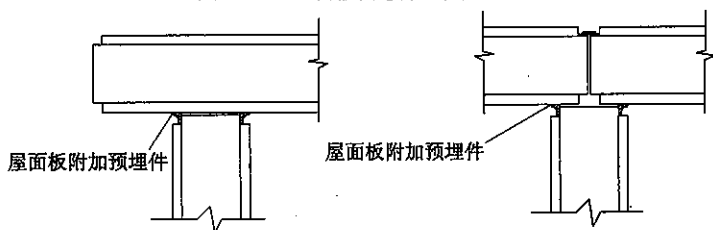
屋面板与山墙板的连接 图 6.3.6-2 屋面板与屋面板的连接
